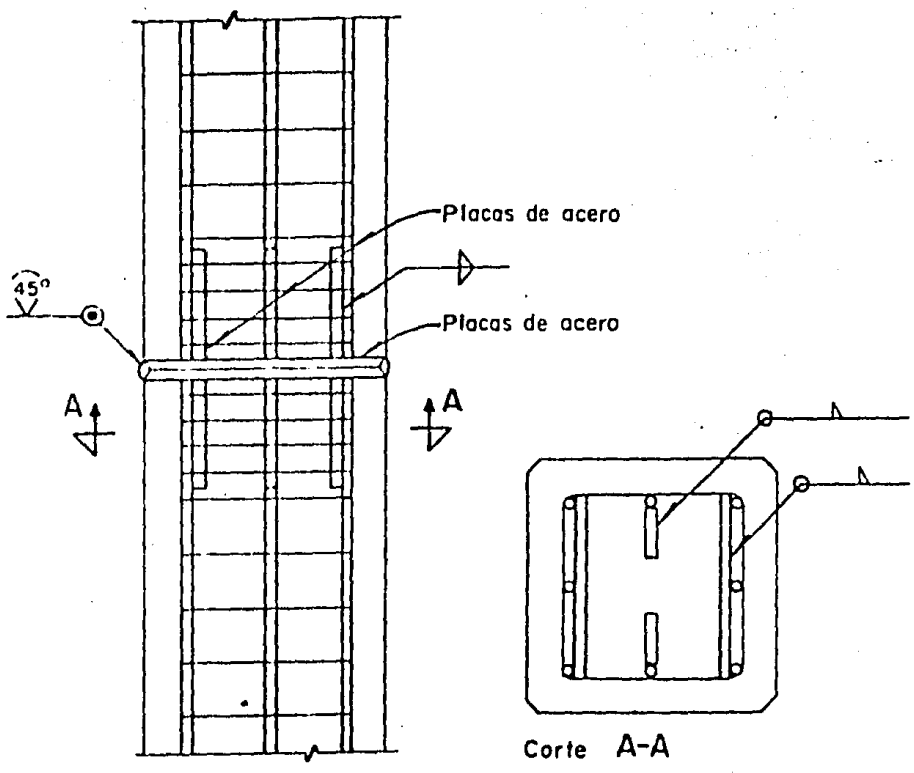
Unión típica de pilotes de concreto reforzado
